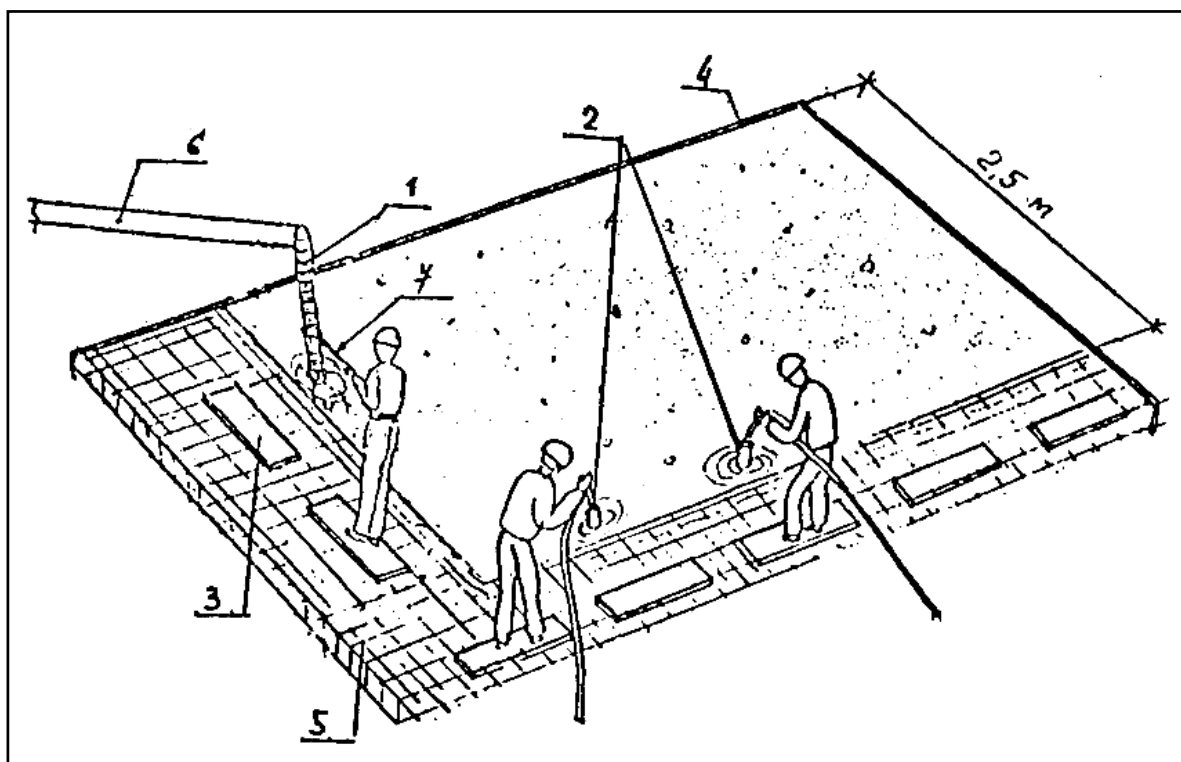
Схема організації робочого місця при бетонуванні плити перекриття
